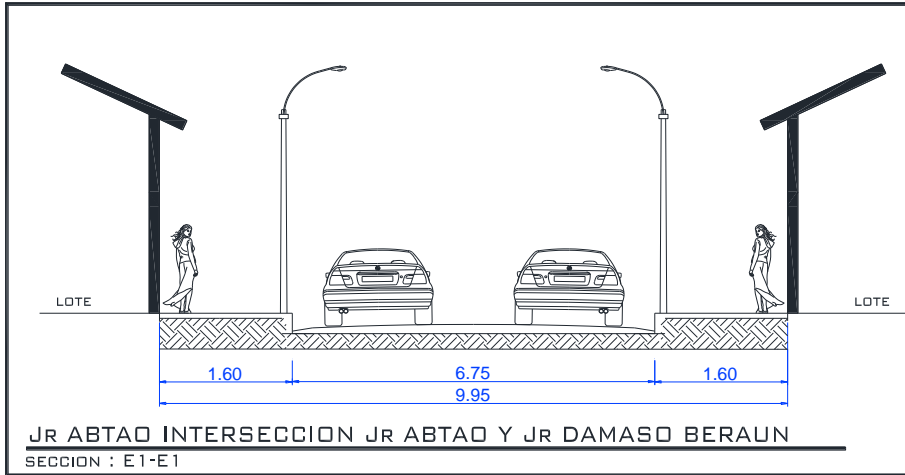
Planta General - Secciones Transversales de las Intersecciones en Estudio
